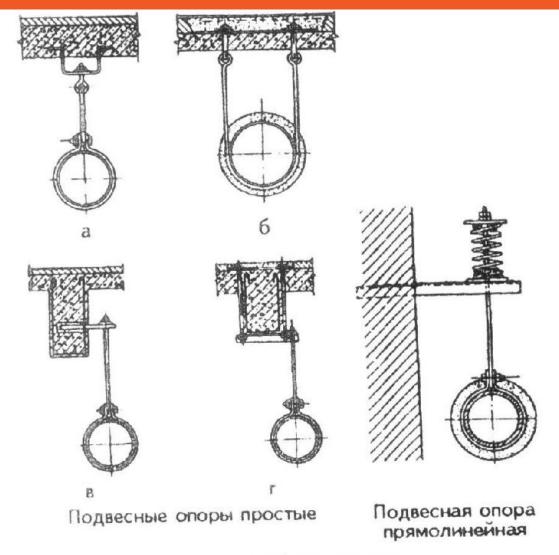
Варианты подвесных опор трубопроводов а – для продольных и поперечных перемещений; б – для продольных перемещений; в – с непосредственной заделкой в балку; г – с обвязкой балки
